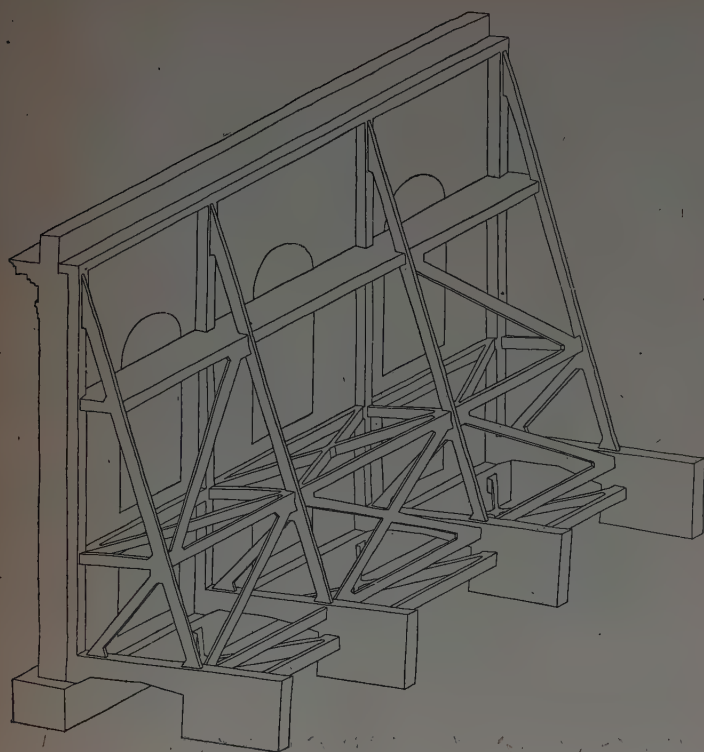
Dispositif en béton armé de contreventement et façade (ensemble déplacé).
